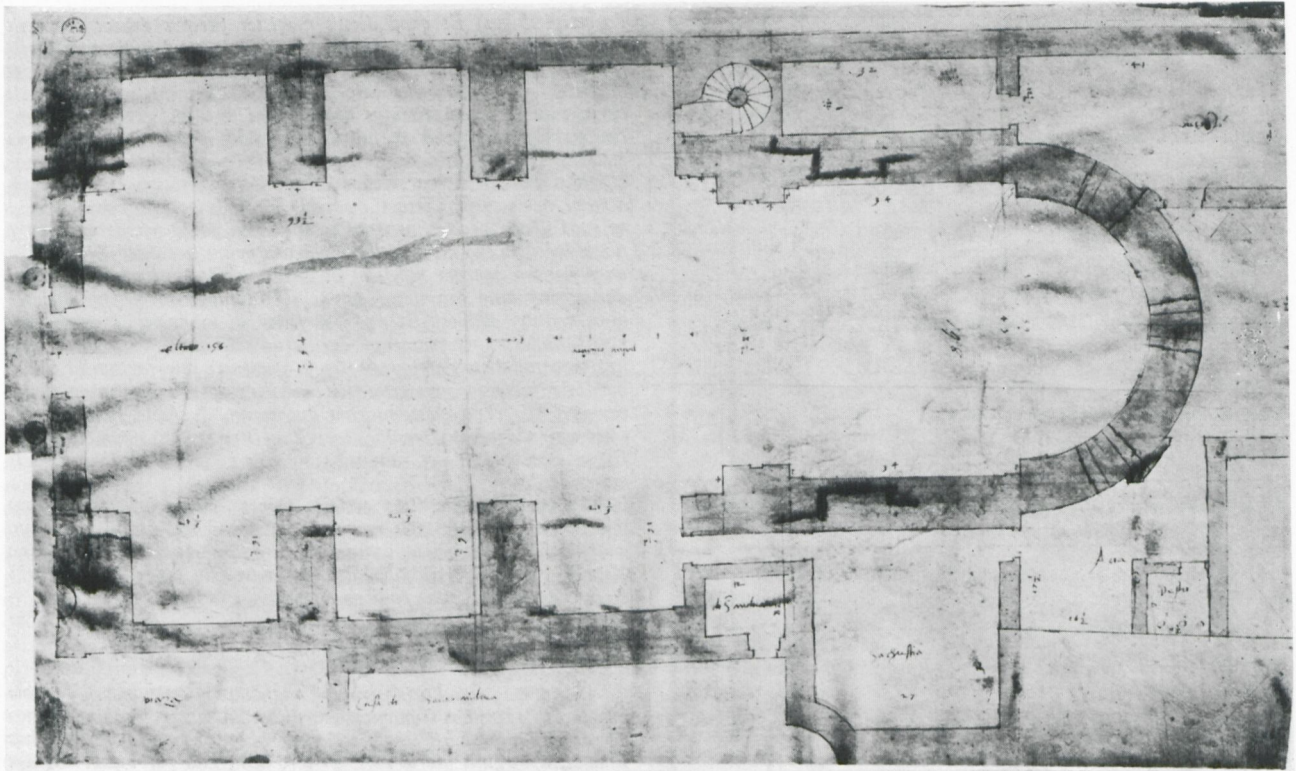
Firenze, Uffizi – A. da Sangallo il Giovane: Progetto per la chiesa di S. Maria di Monserrato. Gabinetto delle Stampe, Arch. 171
